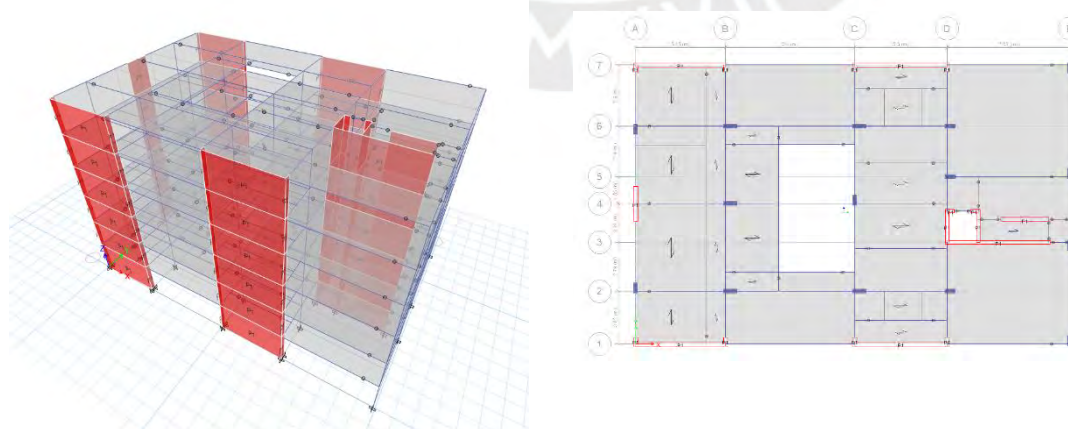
Modelo estructural vista en 3D (izquierda) y vista en planta (derecha).
